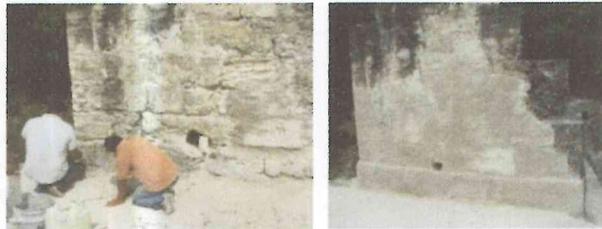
, Vista al inicio de la intervención Foto No.2, Vista después de la intervención
